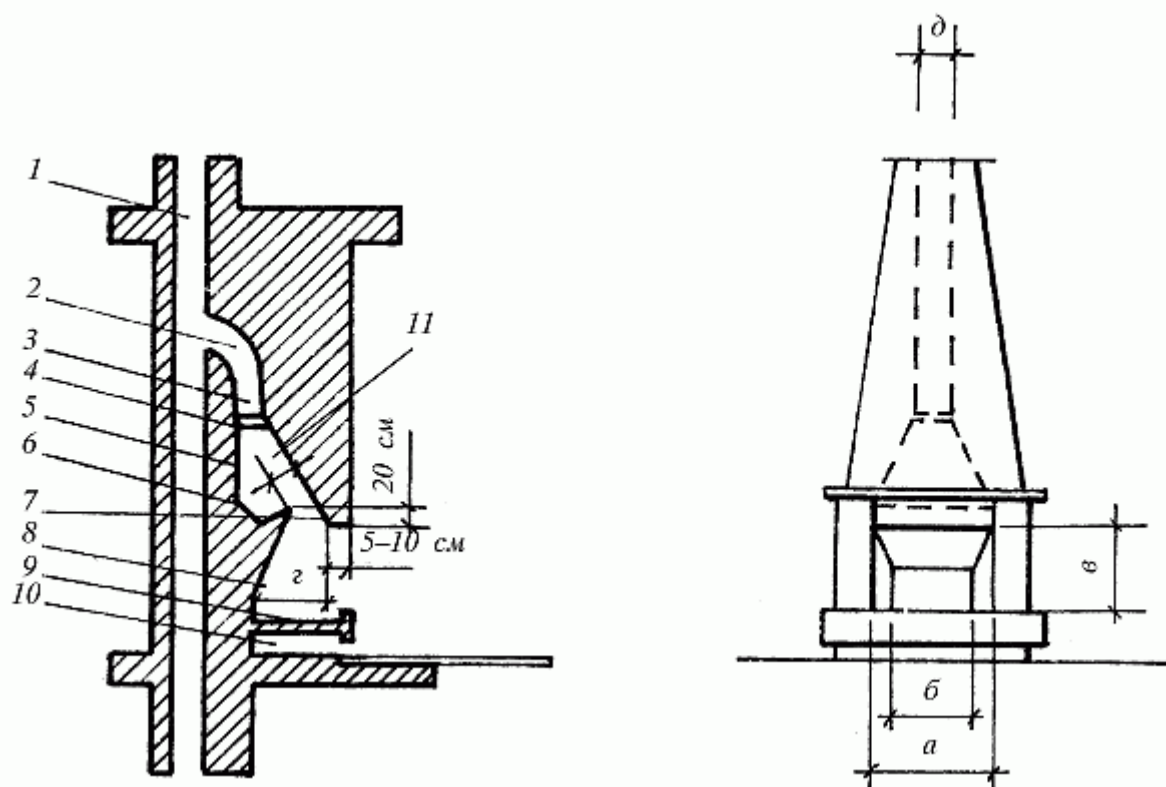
Камин, пристроенный к дымовой трубе: 1 – дымовая труба; 2 – колено; 3 – дымоход; 4 – задвижка; 5 – дымовая камера; 6 – обратное днище; 7 – стенка; 8 – топка; 9 – днище (под); 10 – зольник; 11 – дымовое отверстие (горловина); а – ширина топки; б – ширина задней стенки; в – высота топки; г – глубина топки; д – ширина дымовой трубы
